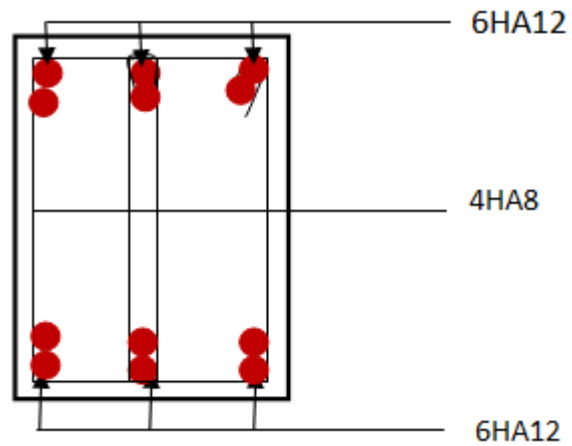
Ferrailage en travée d'une poutre secondaire
